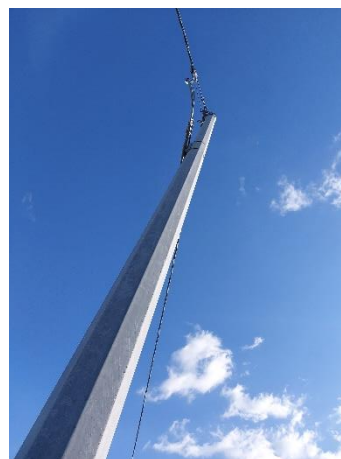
Linea MT sul lato nord dell'AREA NORD – vista dall'area d'impianto
